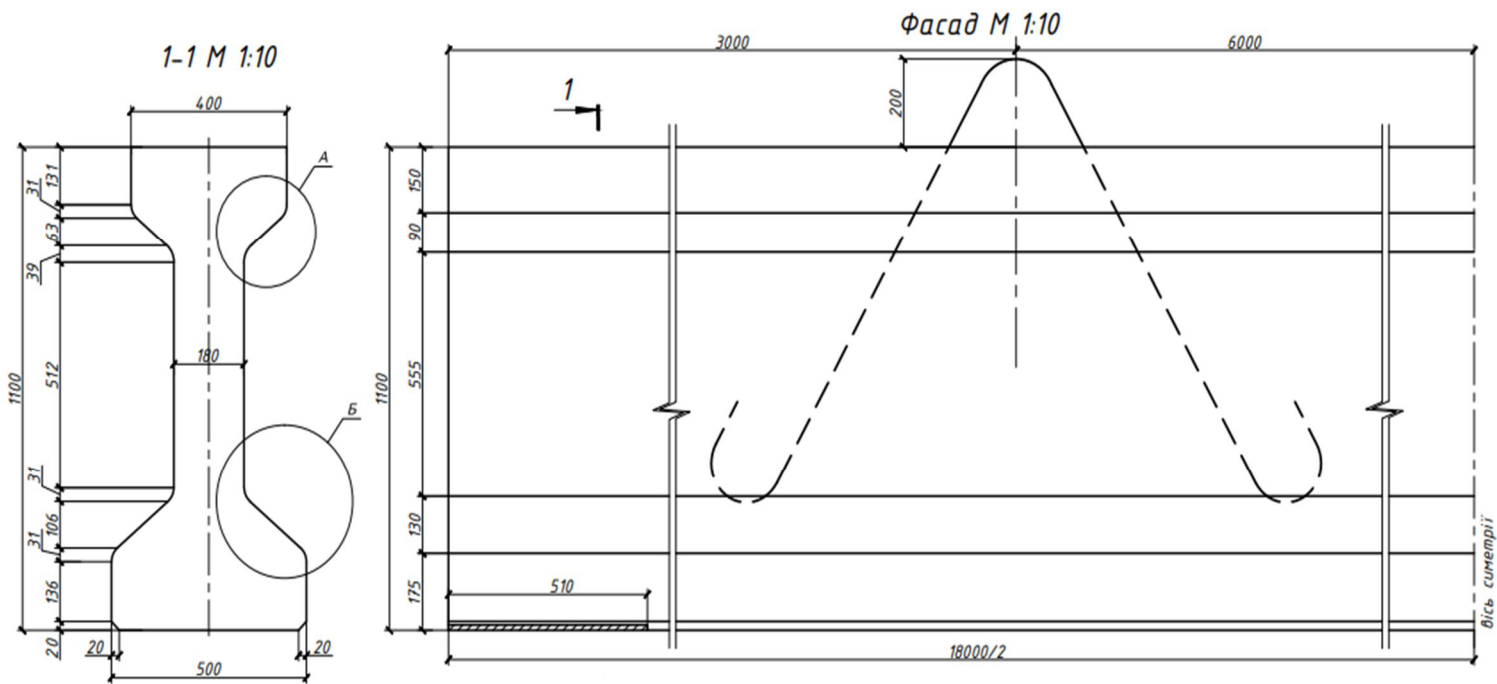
Фасад та поперечний переріз балки 18 м
